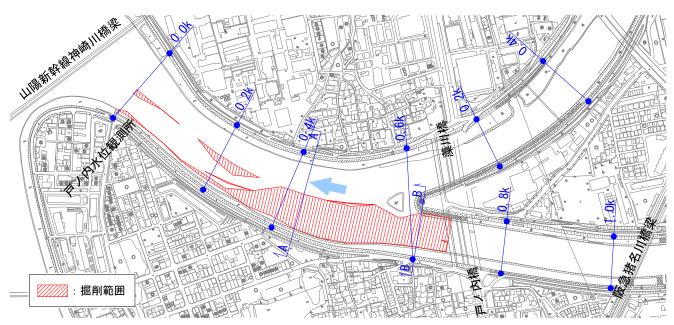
戸ノ内(H24 工事)地区 平面図
